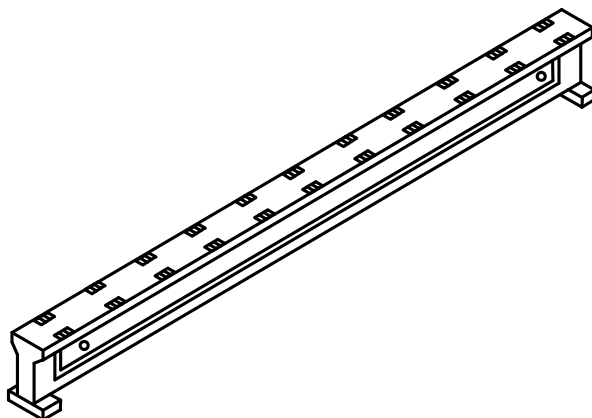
Железобетонные стропильные балки (односкатные)
